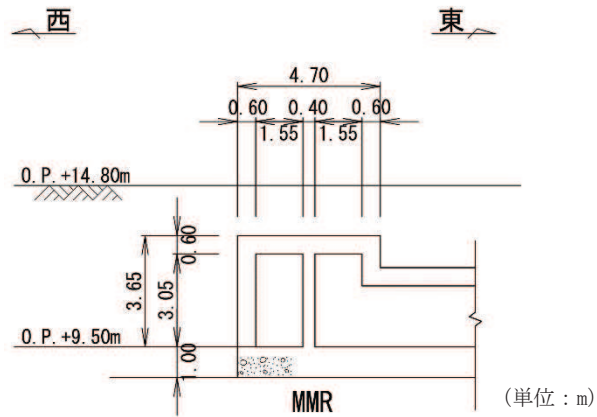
軽油タンク連絡ダクト平面図 (詳細)
